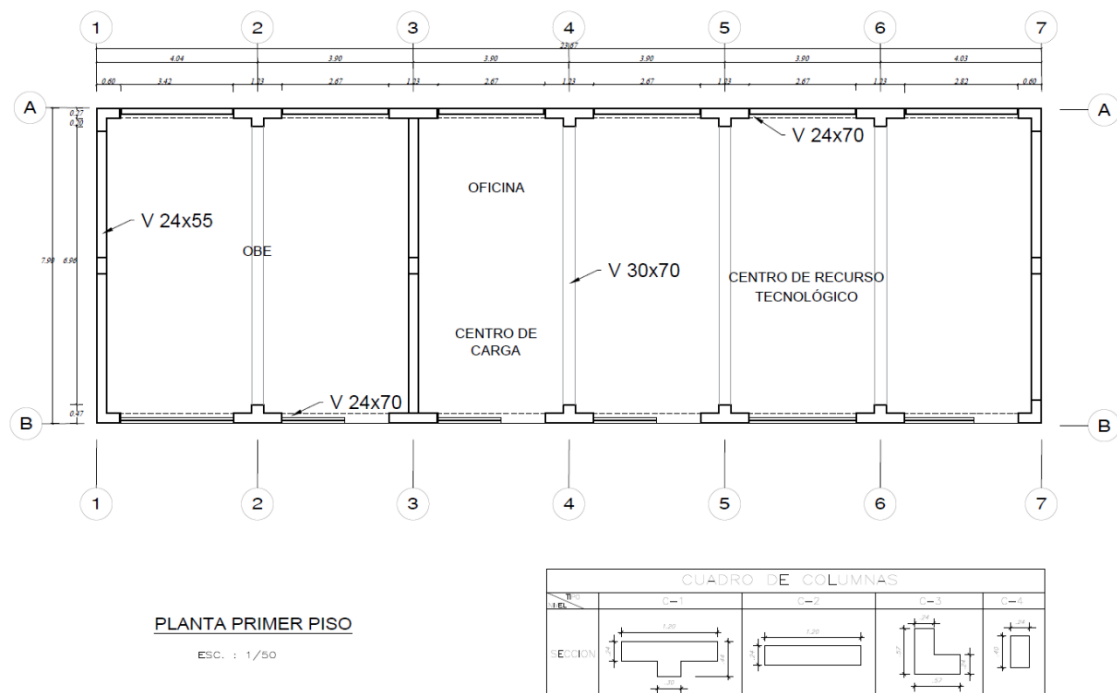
Plano de distribución de la I.E Karl Weiss-Pabellón 3, módulo 1
